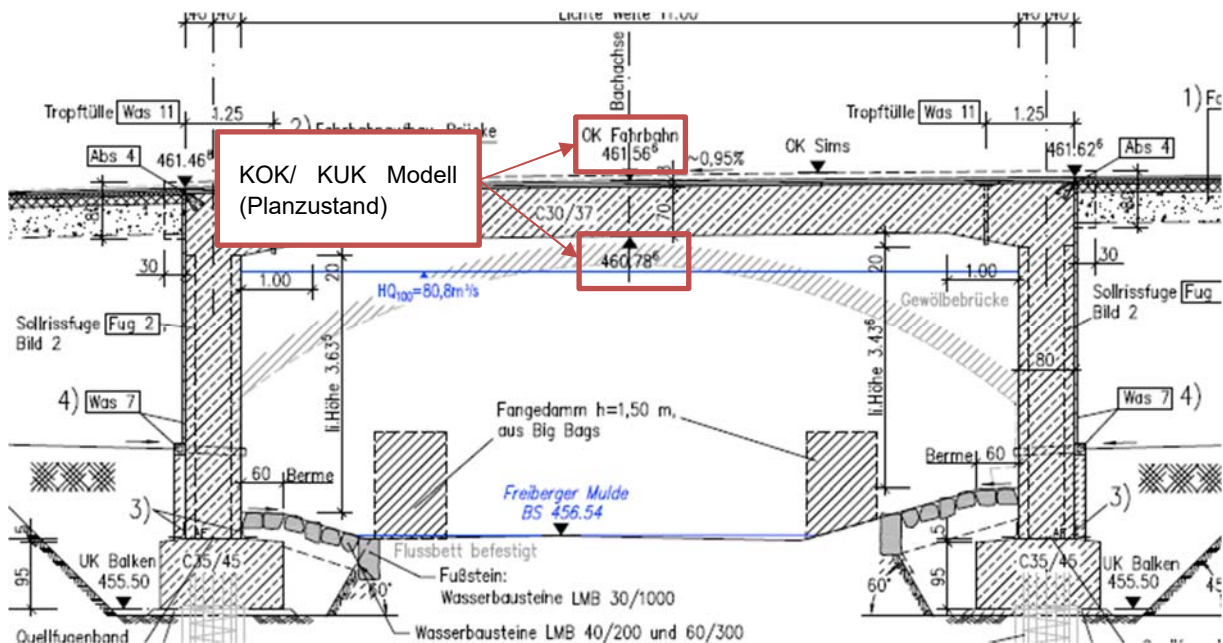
Brückenquerschnitt Fangdämme lt. Planung [g4] Ist- und Planzustand
